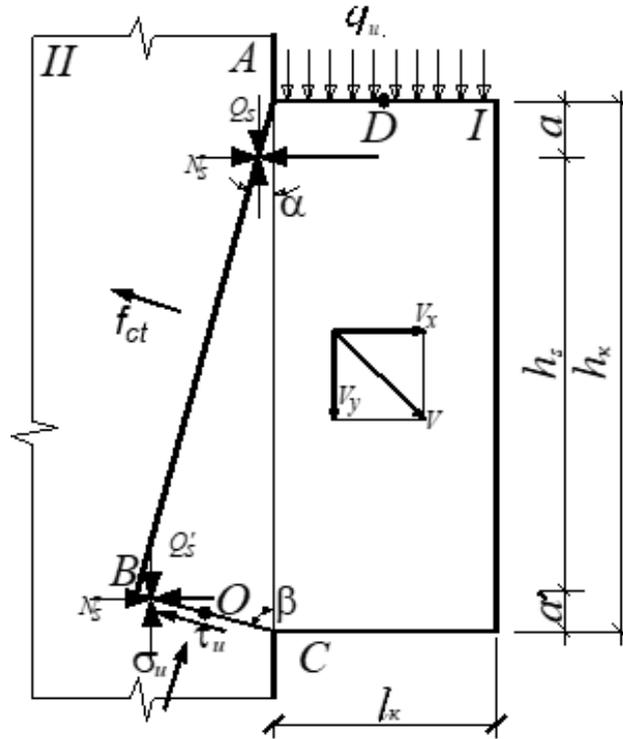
Кінематично можлива схема руйнування прямокутних залізобетонних шпонок при зрізі у разі розташування арматури в два яруси і врахуванні нагельного ефекту в усій арматурі
